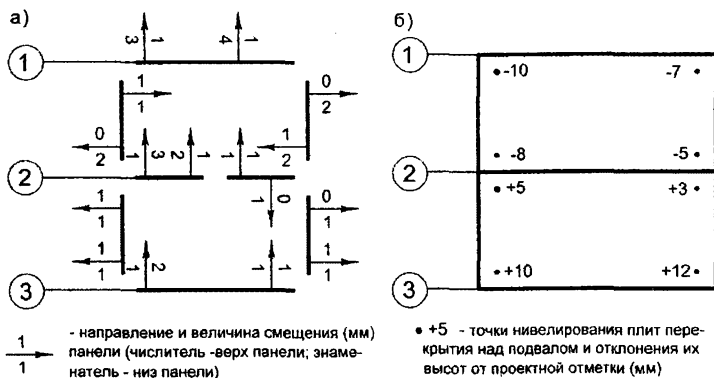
Исполнительная схема планового положения стен (а) и высотного положения плит перекрытия подземной части здания (б)
